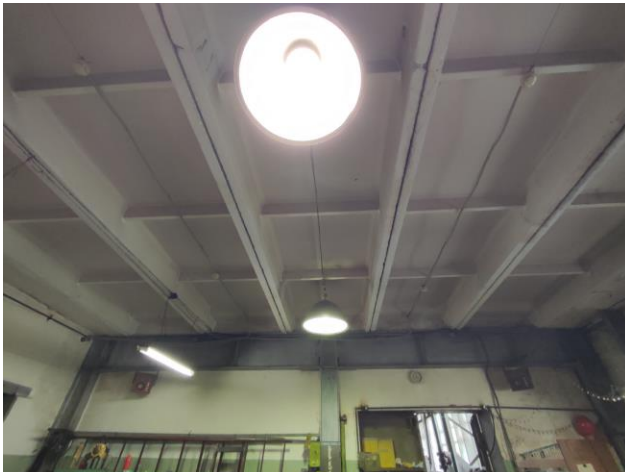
Вид на конструкции перекрытия. Коррозия металлических элементов перекрытия. Следы замачивания.
